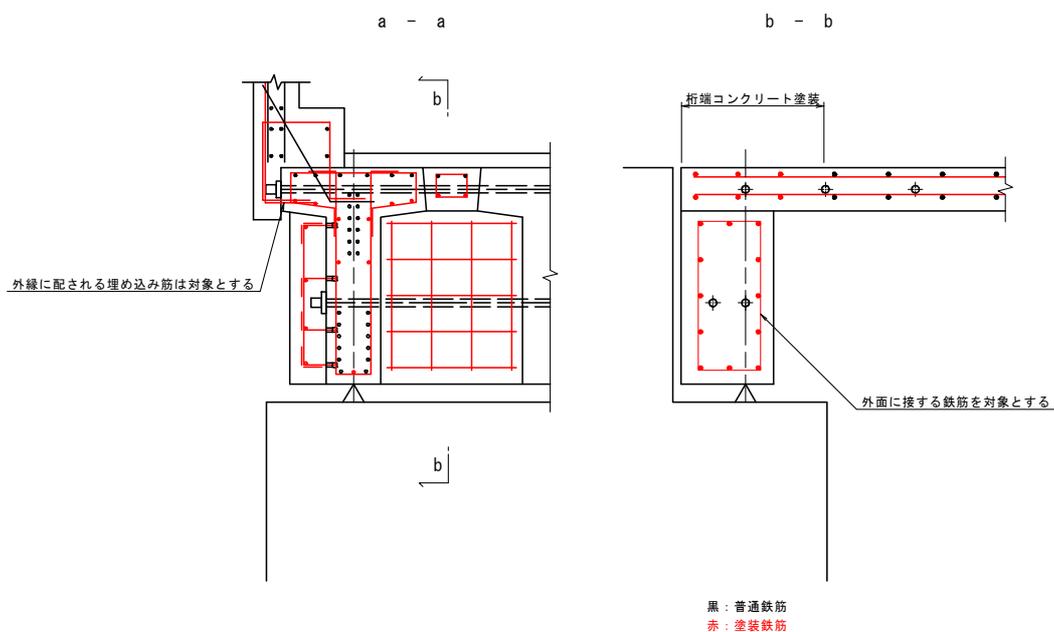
プレテンション方式T桁橋の塗装鉄筋配置案
